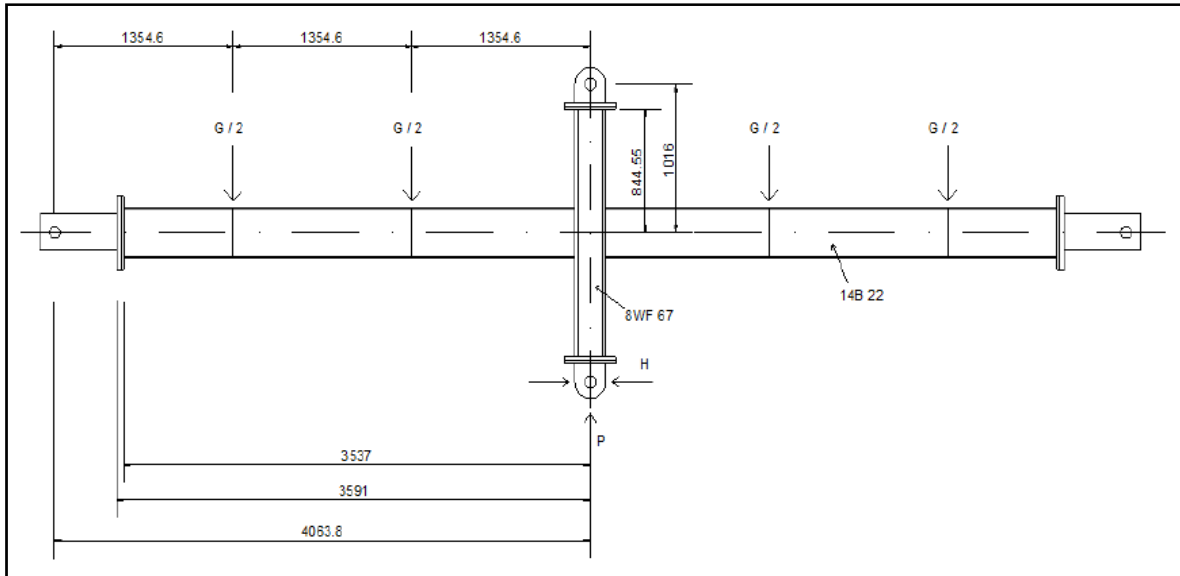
Configuración de la prueba (dimensiones en mm) de Krawinkler et al. (1971)
